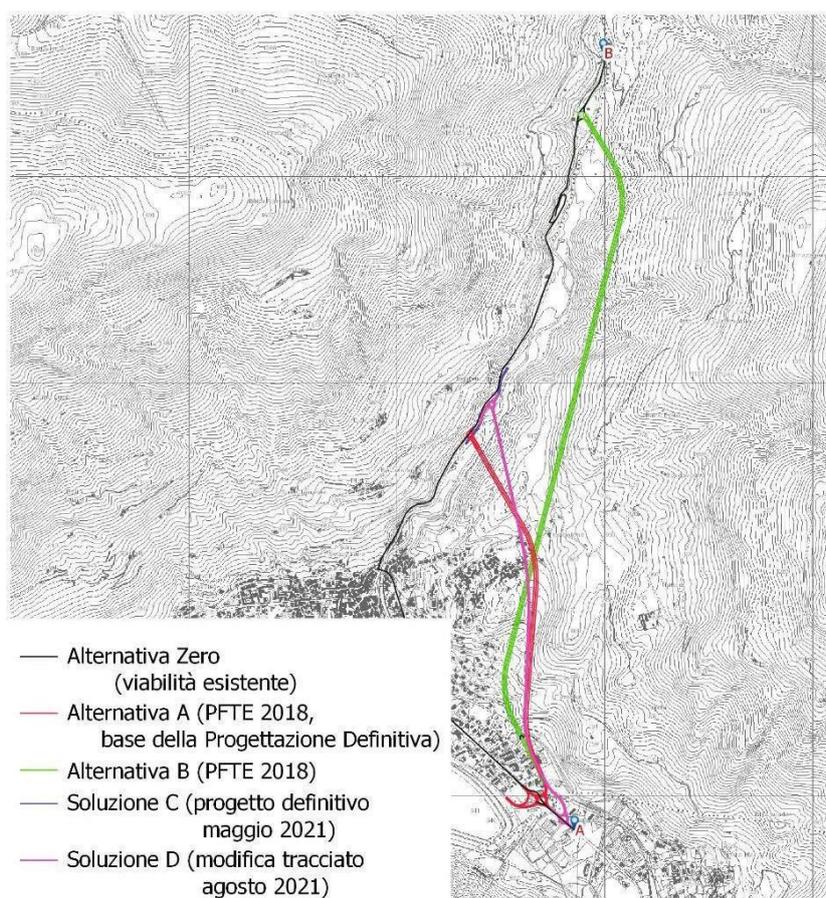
Dettaglio della planimetria delle quattro soluzioni alternative di progetto
